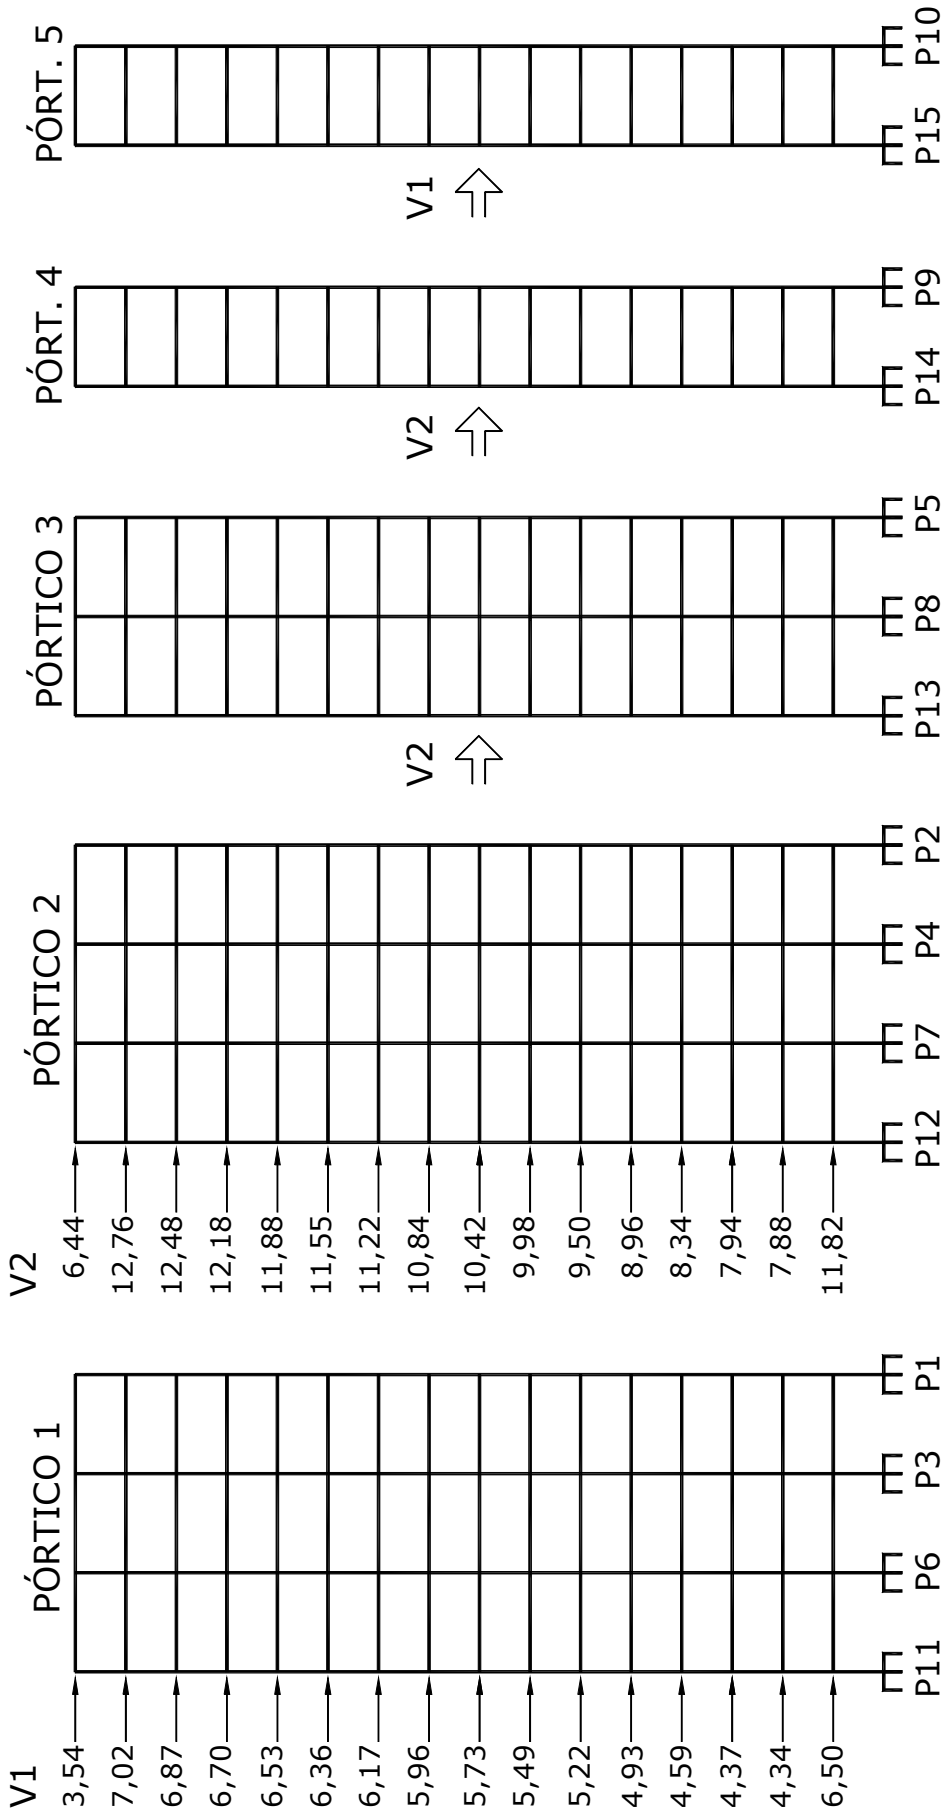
Modelo Pórticos Planos Independentes com Áreas de Influência (PPI-AI) da Estrutura 4: elevação dos pórticos e esquema do carregamento (em kN).
